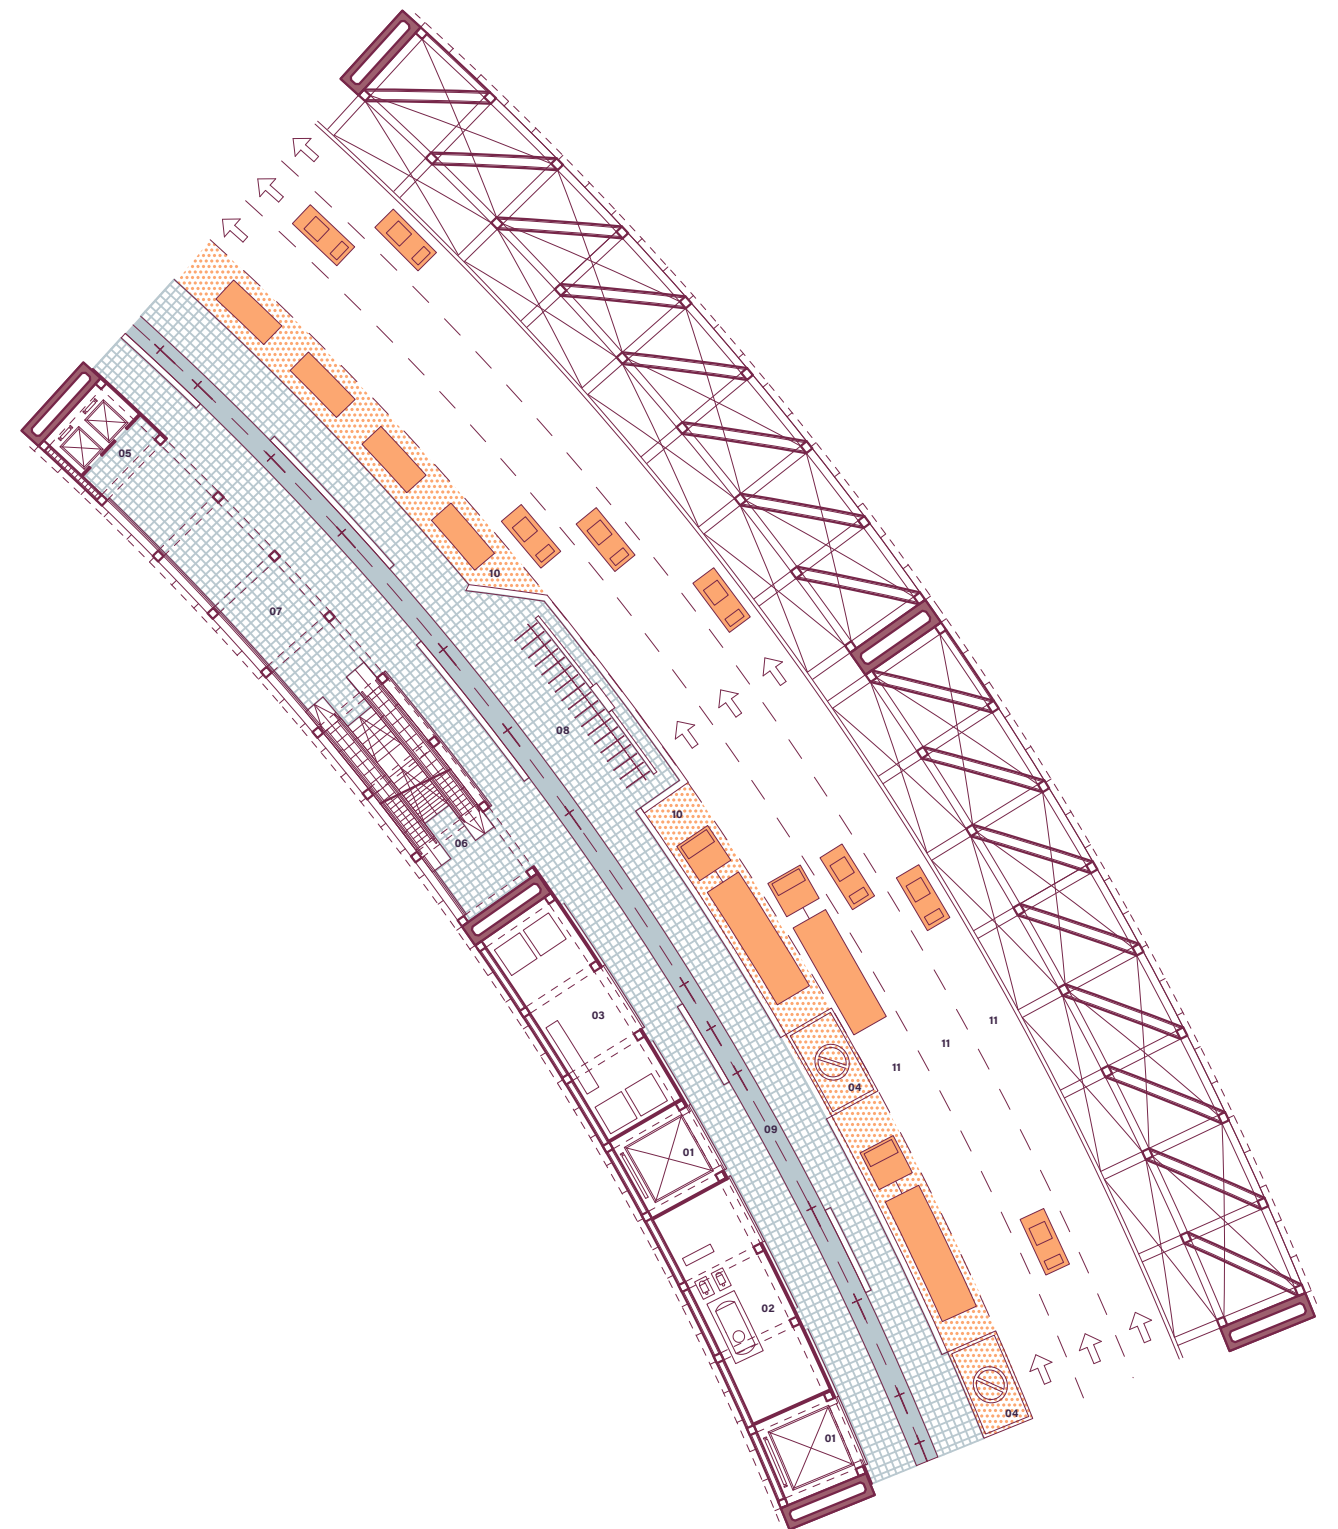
Sectores ampliados de planta +5.40. De izquierda a derecha: módulo de acceso S1 y módulo genérico S2. Fuente: Elaboración propia.
